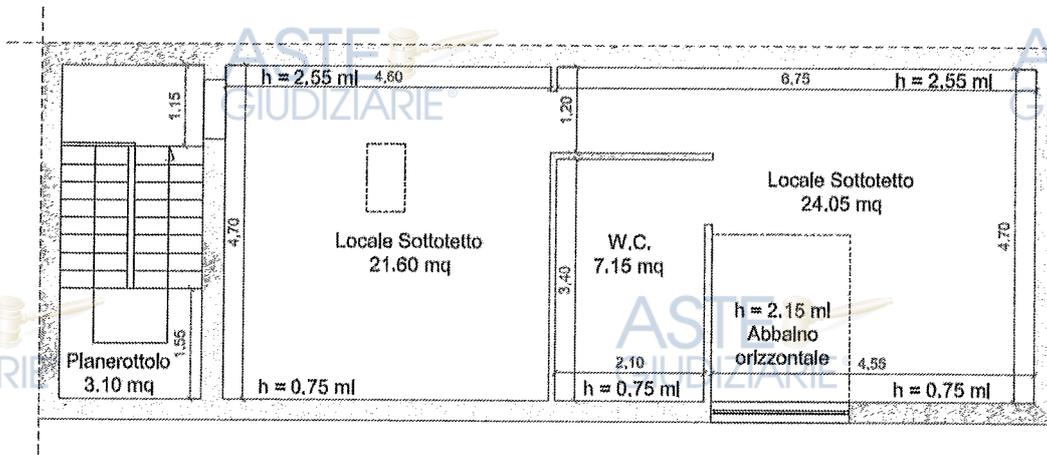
Planimetria Catastale Foglio 47, p.lla 1393, sub 11 e p.lla 1394, sub 13 (graffate tra di loro) - Piano 2
